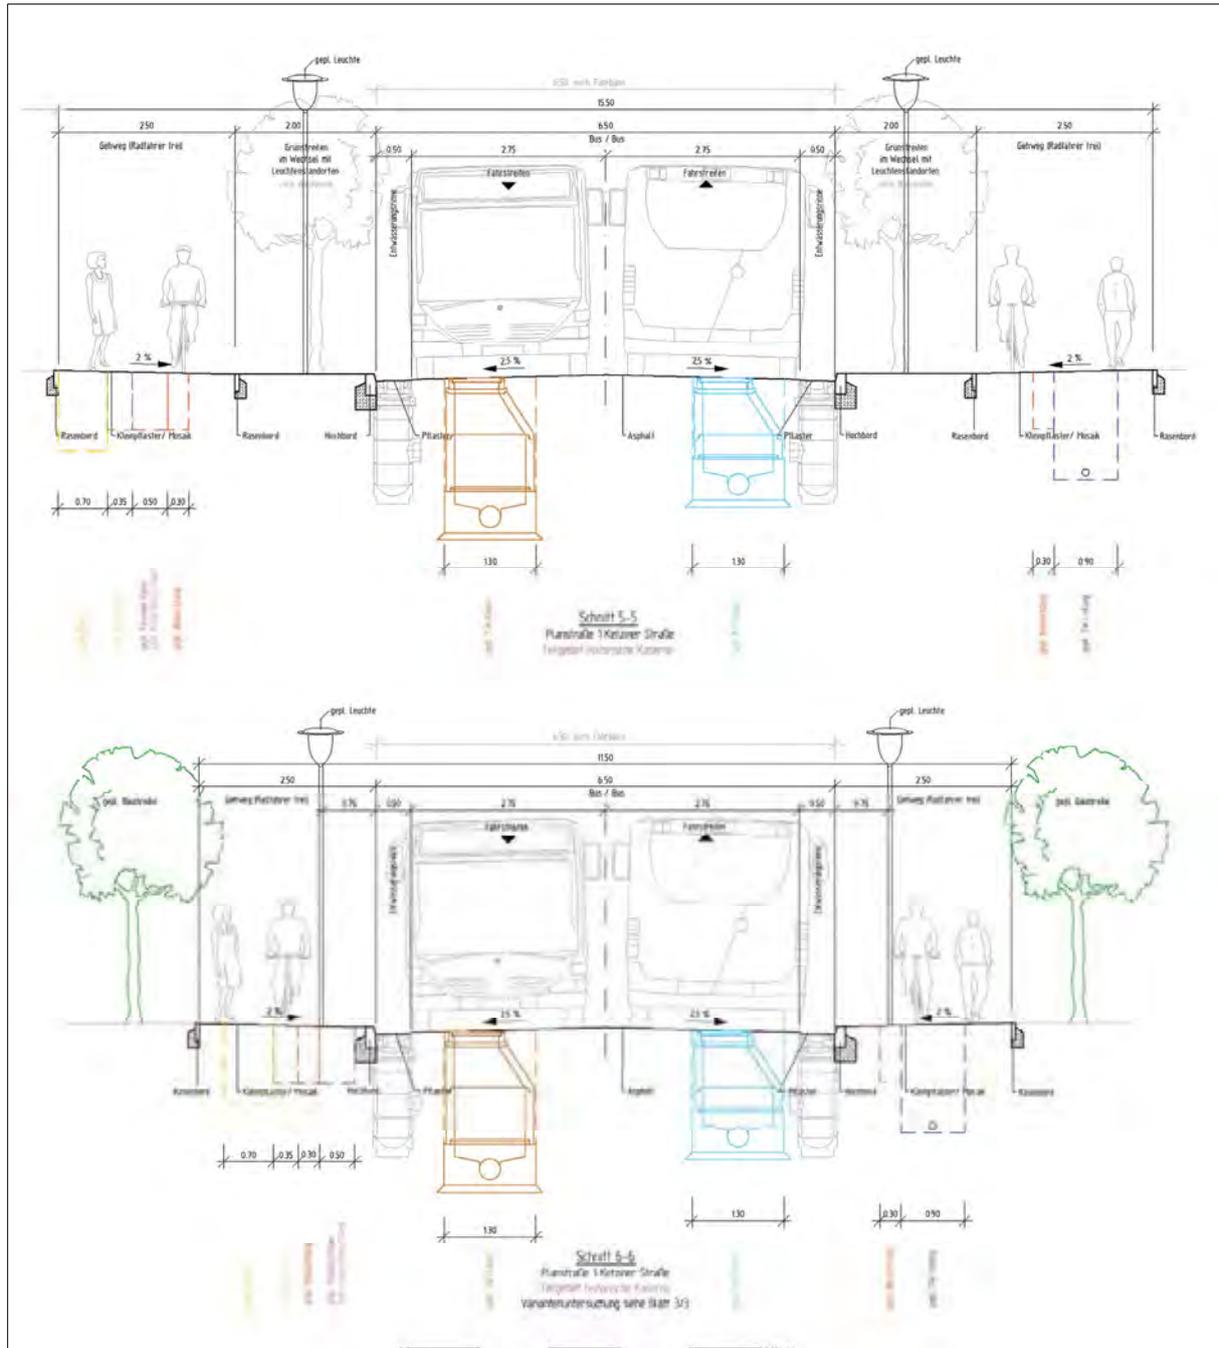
Erschließung, Straßenquerschnitt 5-5/ 6-6; Planstraße 1/Ketziner Straße
